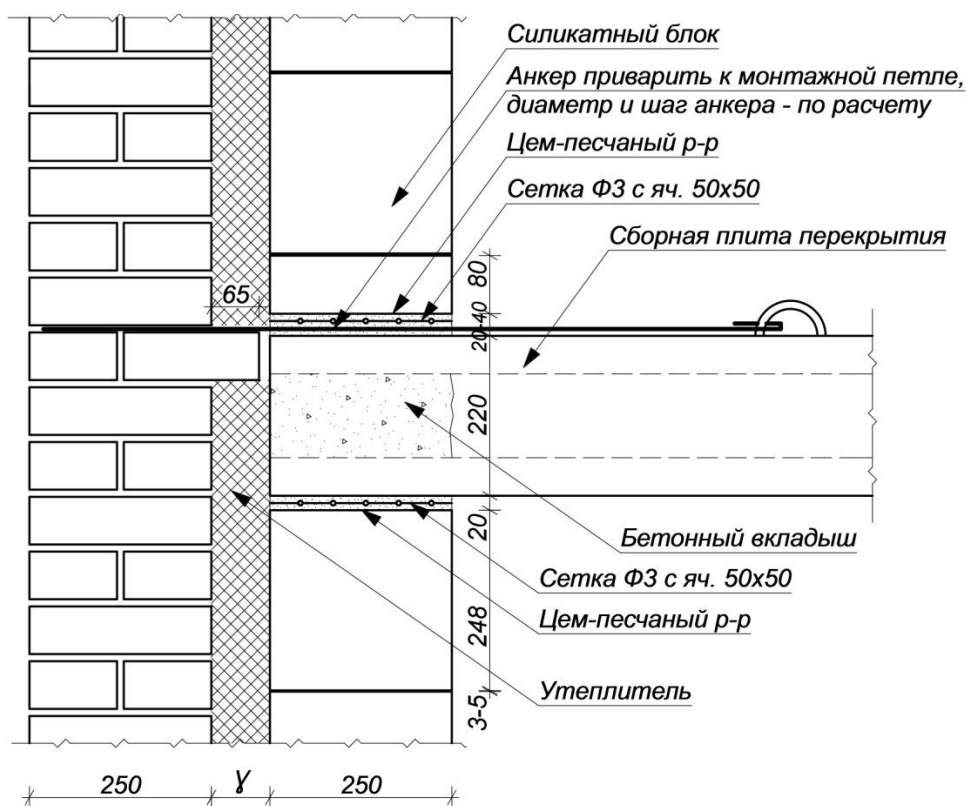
Узел анкерки самонесущего облицовочного слоя в уровне перекрытий
